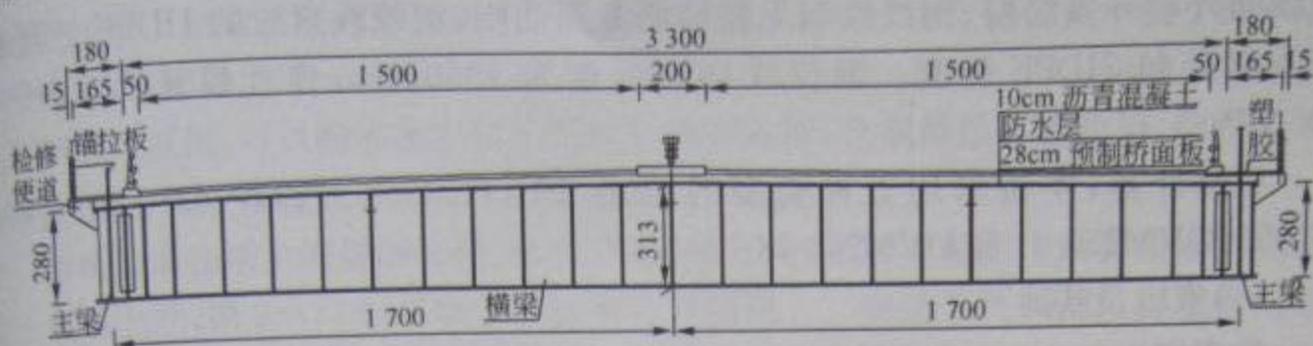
主桥主梁标准横断面(尺寸单位:cm)
